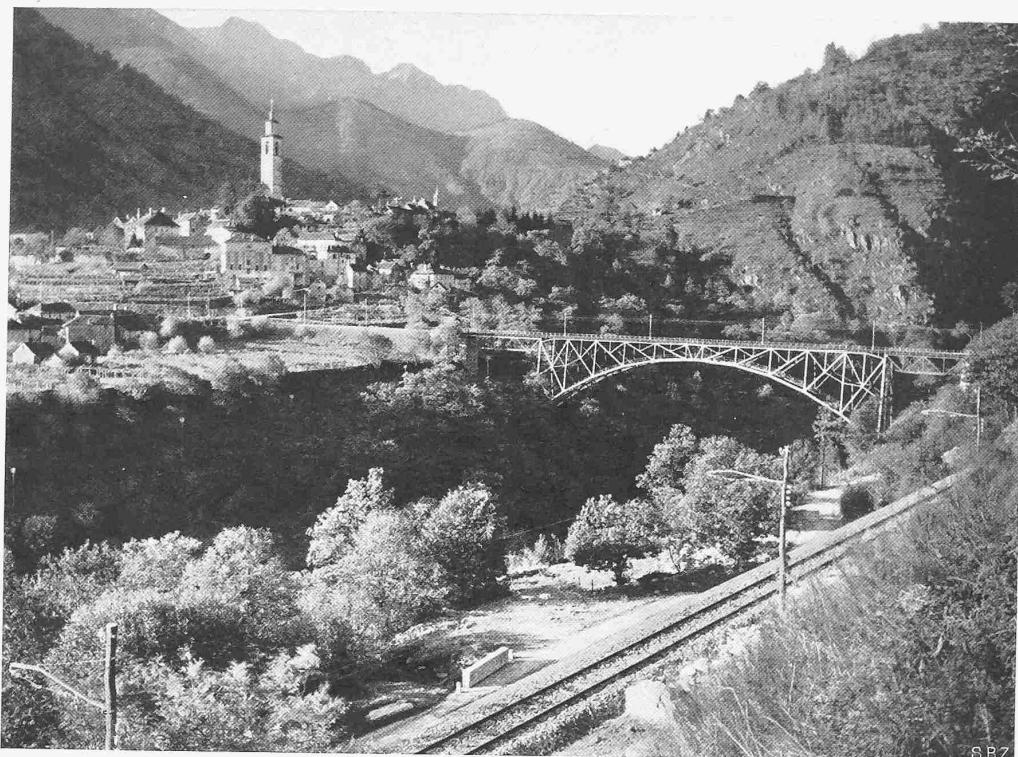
Ruinacci-Brücke bei Camedo (nach Vollendung der Eisenkonstruktion). Stützweite 65,920 m, Gefälle 3⁰/₀₀.
